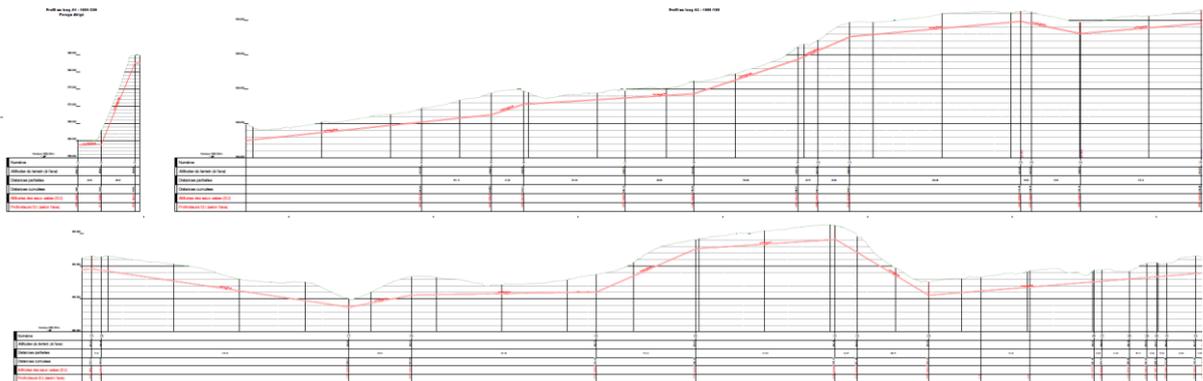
Profil en long de la conduite de refoulement (27.11.2024)
